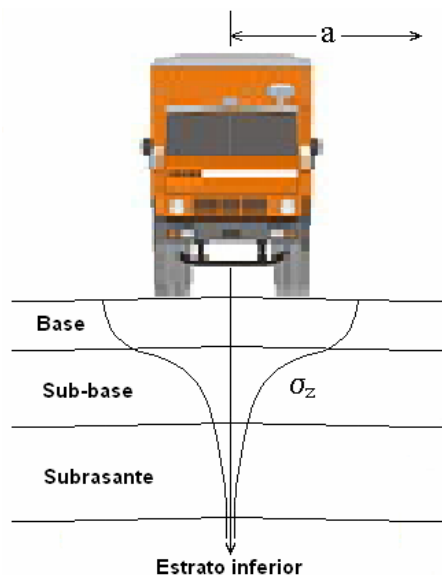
Distribución de esfuerzos propuesto por Boussinesq en las capas de un pavimento.
